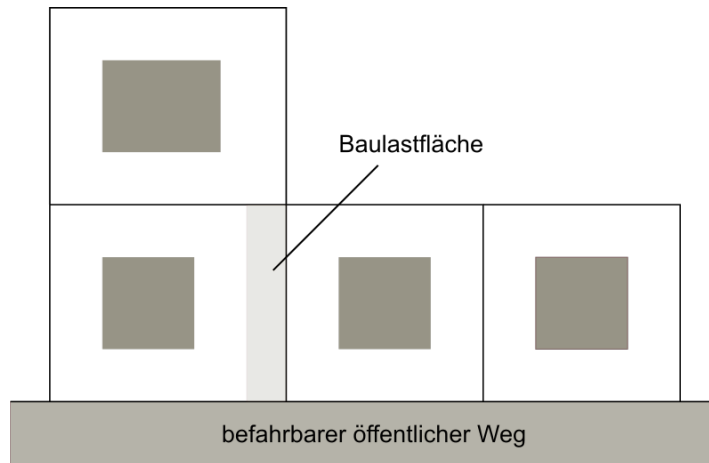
Baulasterschließung eines hinteren Grundstücks
